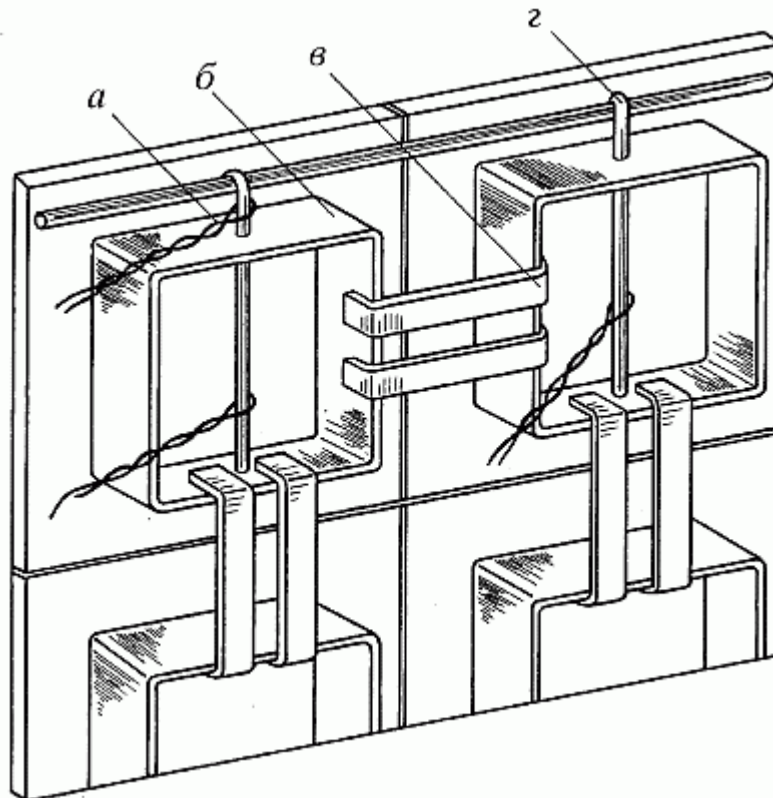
Скрепление изразцов: а – проволока; б – румпа; в – скобы; г – проволочный штырь
